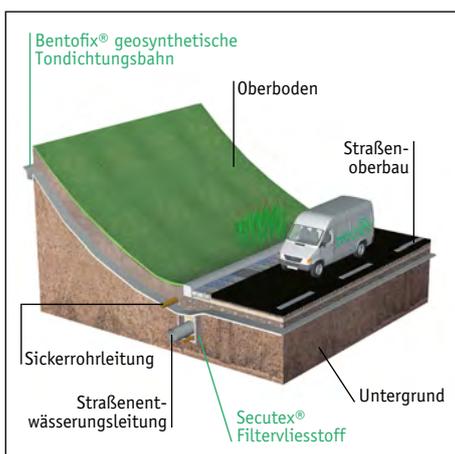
Straßendichtungssystem nach RiStWag mit Bentofix®
